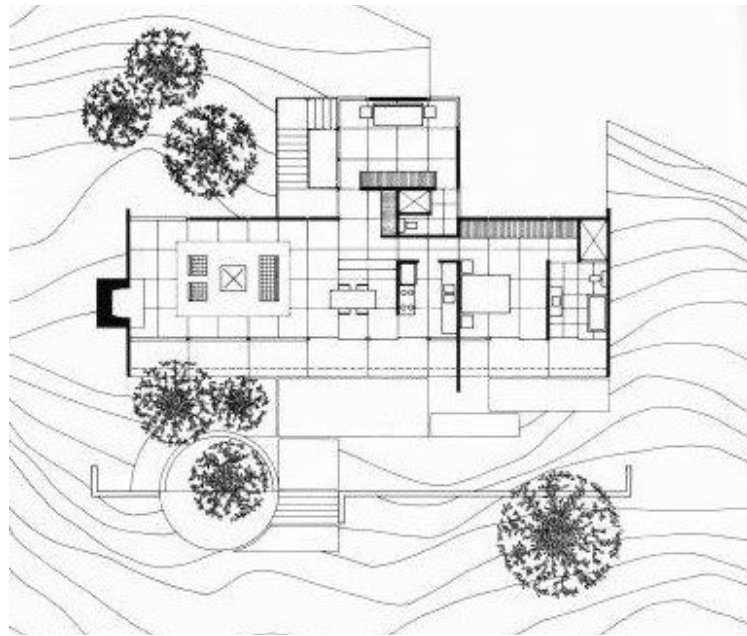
Craig Ellwood, Hale House, LA, 1949, Grundriss
